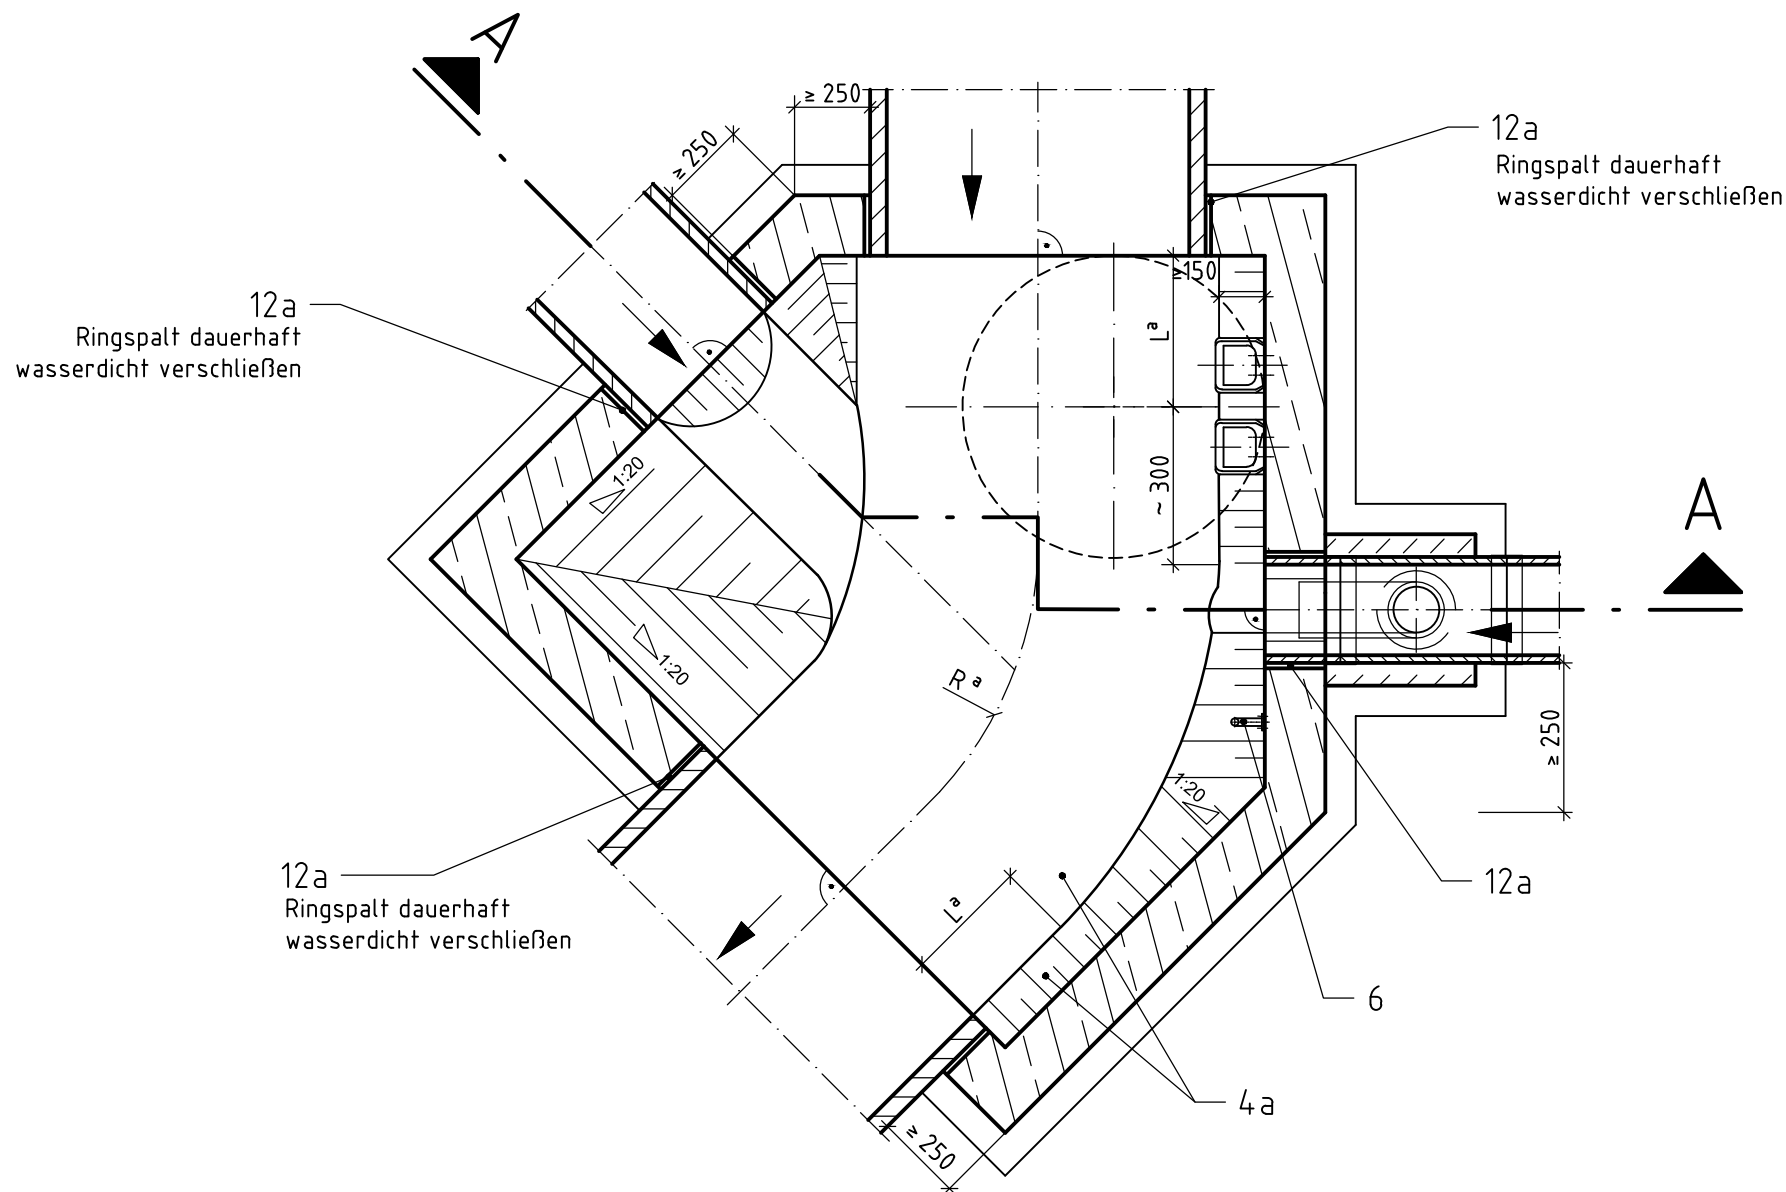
Kammerbauwerk aus Stahlbetonfertigteilen mit Steinzeugrohr
